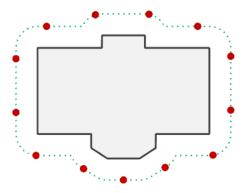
Расстановка расчётных точек по фасаду здания
